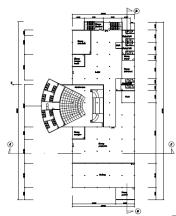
Denah lantai 1 Fasilitas Pengelola
